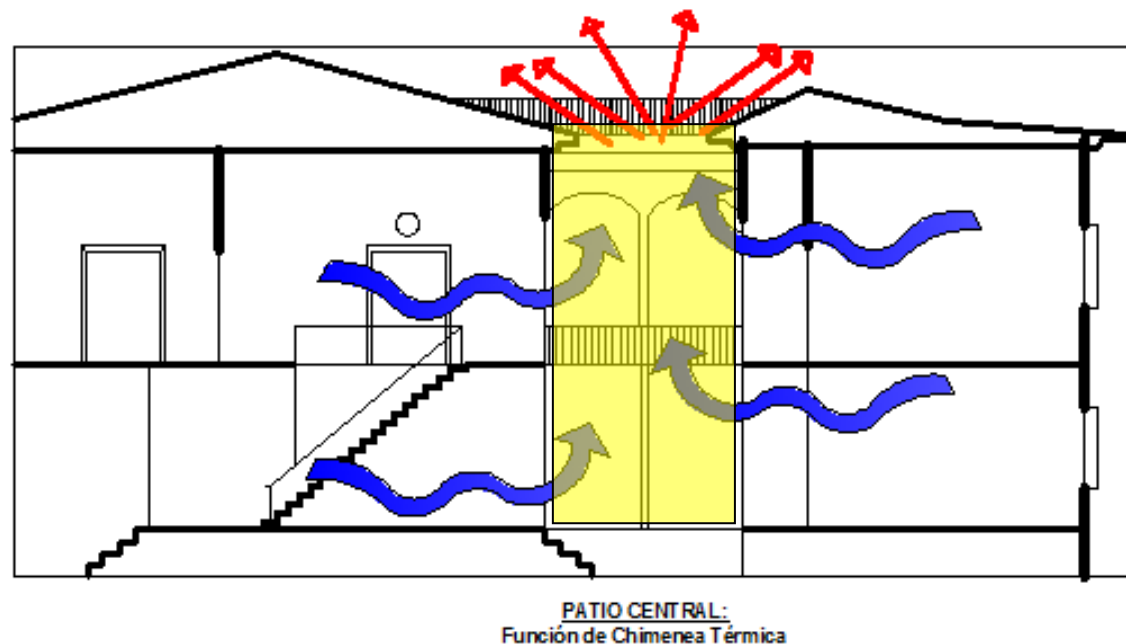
Corte Esquemático. Eliminación del aire caliente al exterior "Chimenea Térmica"
